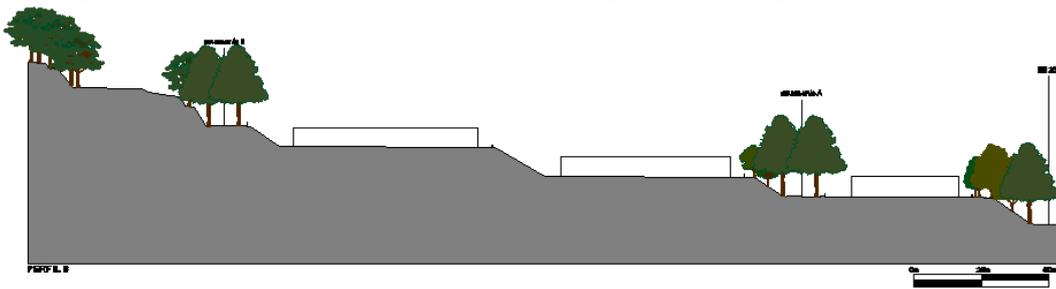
Plano Geral do Projeto de Integração Paisagista
